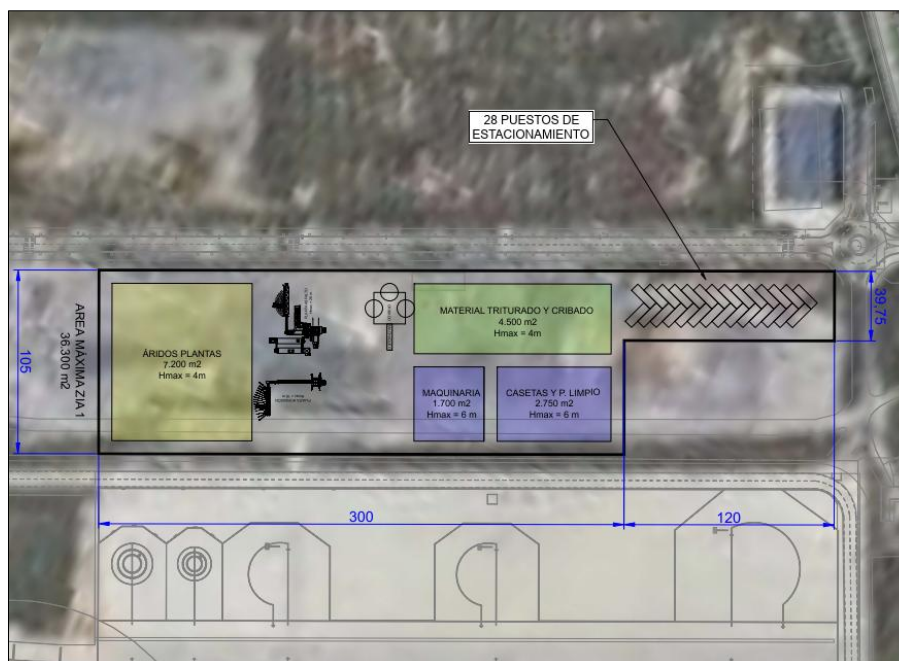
Configuración ZIA 2. Cierre de la pista 06R-24L
